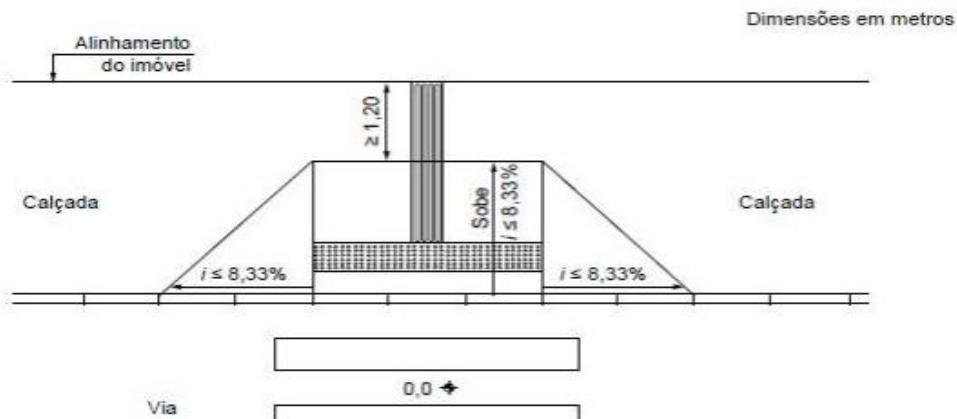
Rampas com piso tátil para deficientes visuais em faixa não elevada, e calçada larga. Vista em Planta.
